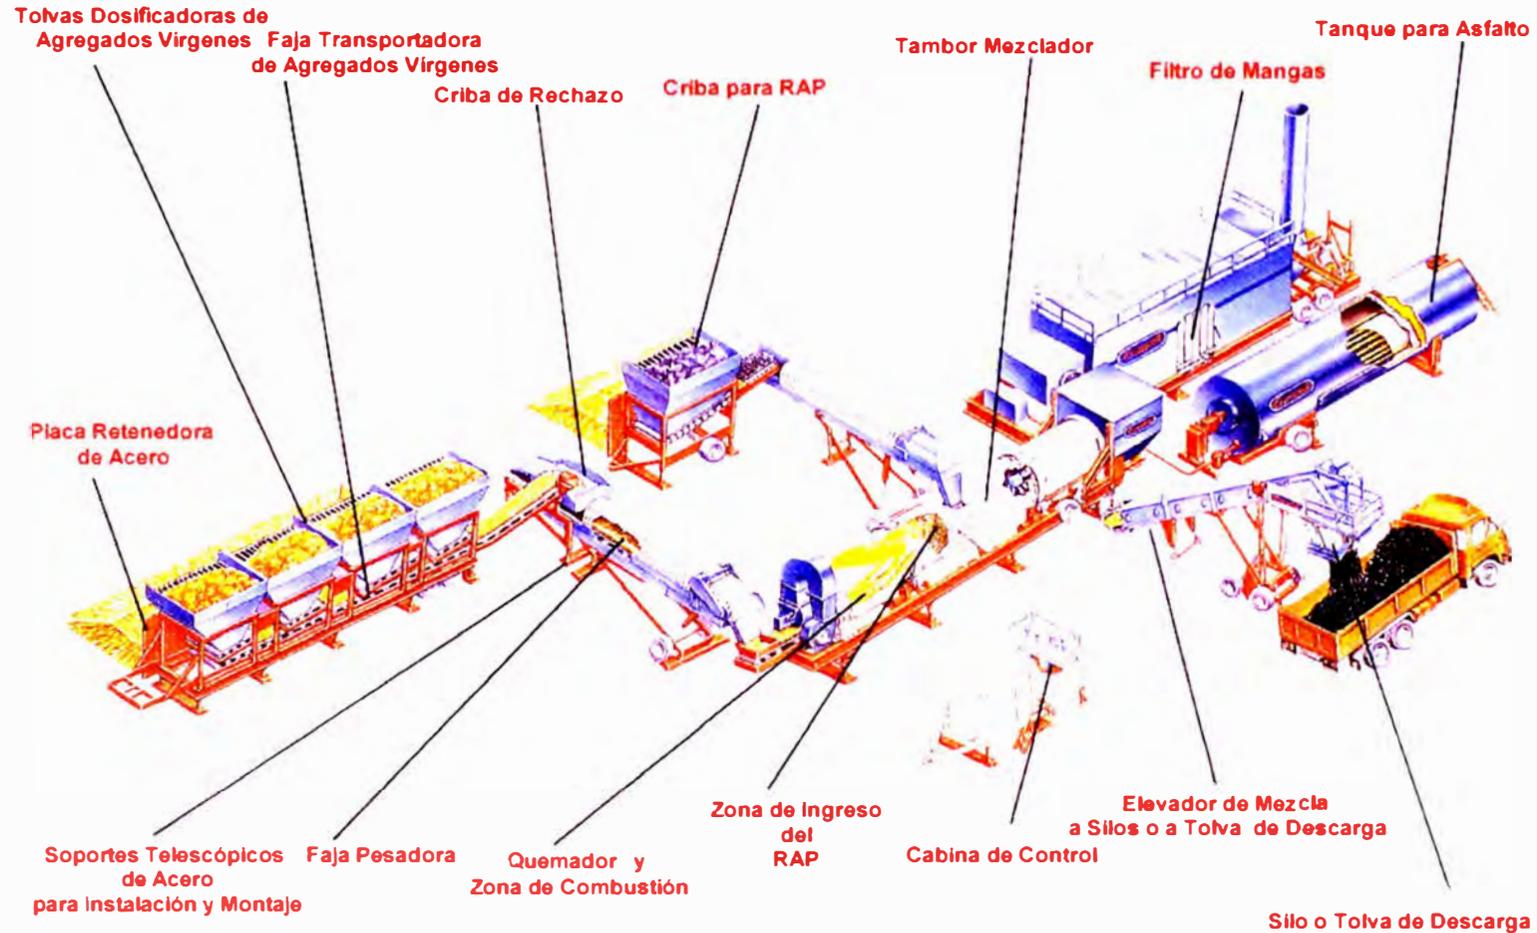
Layout de una planta con tambor mezclador de flujo paralelo
